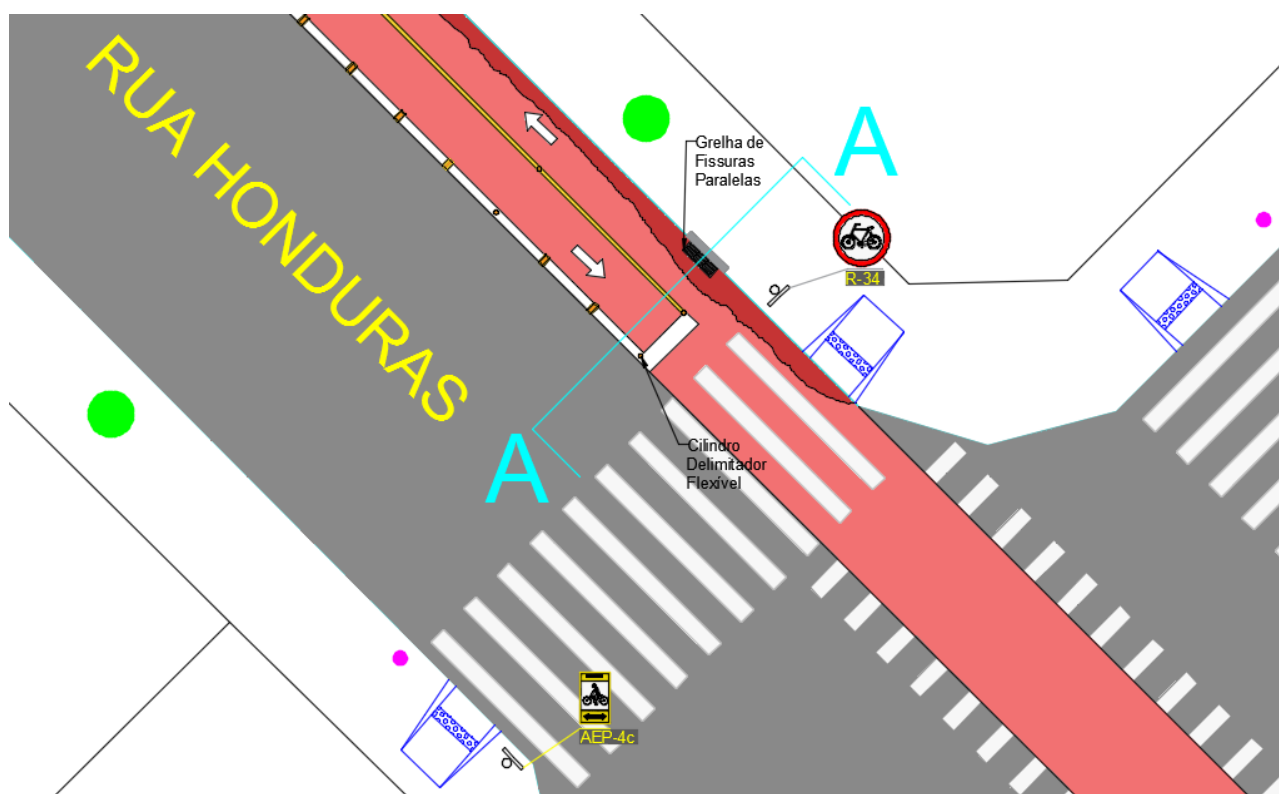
Planta do cruzamento em questão (Fonte: Autoria própria)
